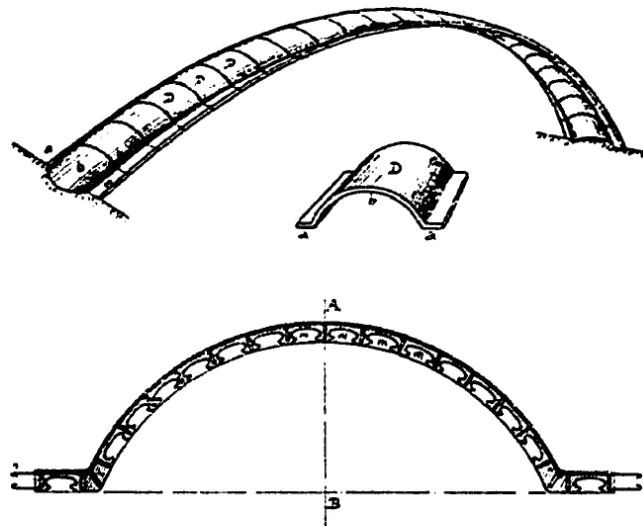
Arco-onda* para cubierta y sección de «dovela-onda». (Imágenes tomadas de [Sánchez del Río 1957, 208]).
